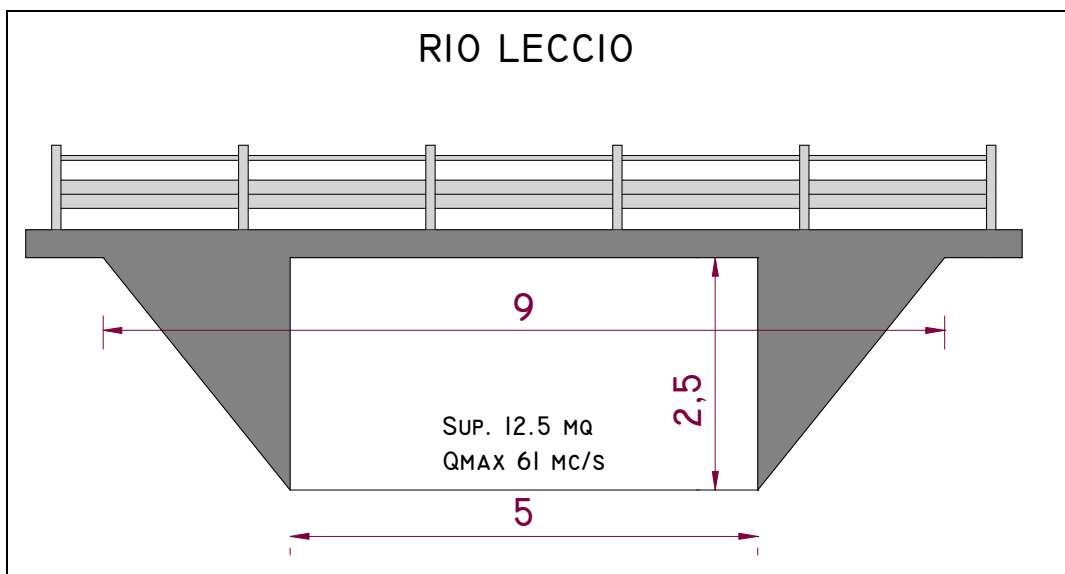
Sezione Rio Leccio (Foto 6 - Tav. 2)
